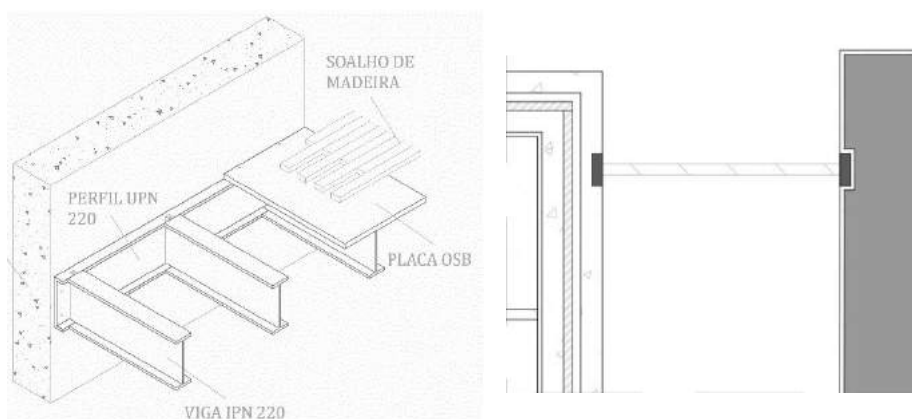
Pormenores de ligação entre construção existente e novas intervenções
